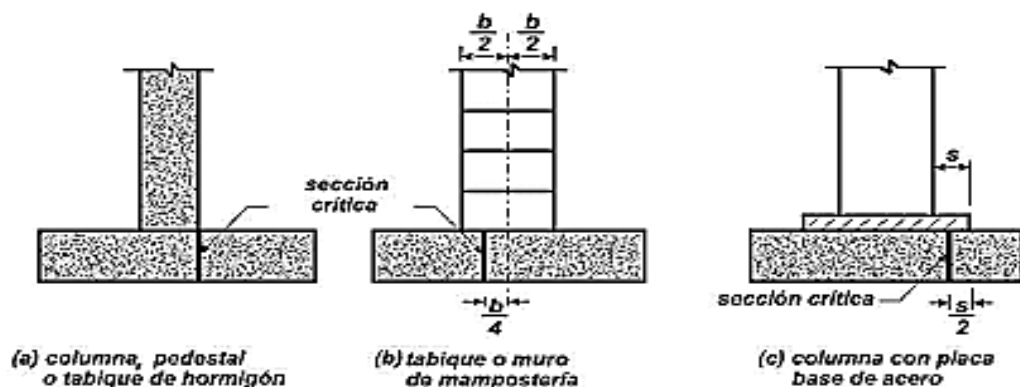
Ubicación de las secciones críticas para momento máximo mayorado en zapatas y cabezales
